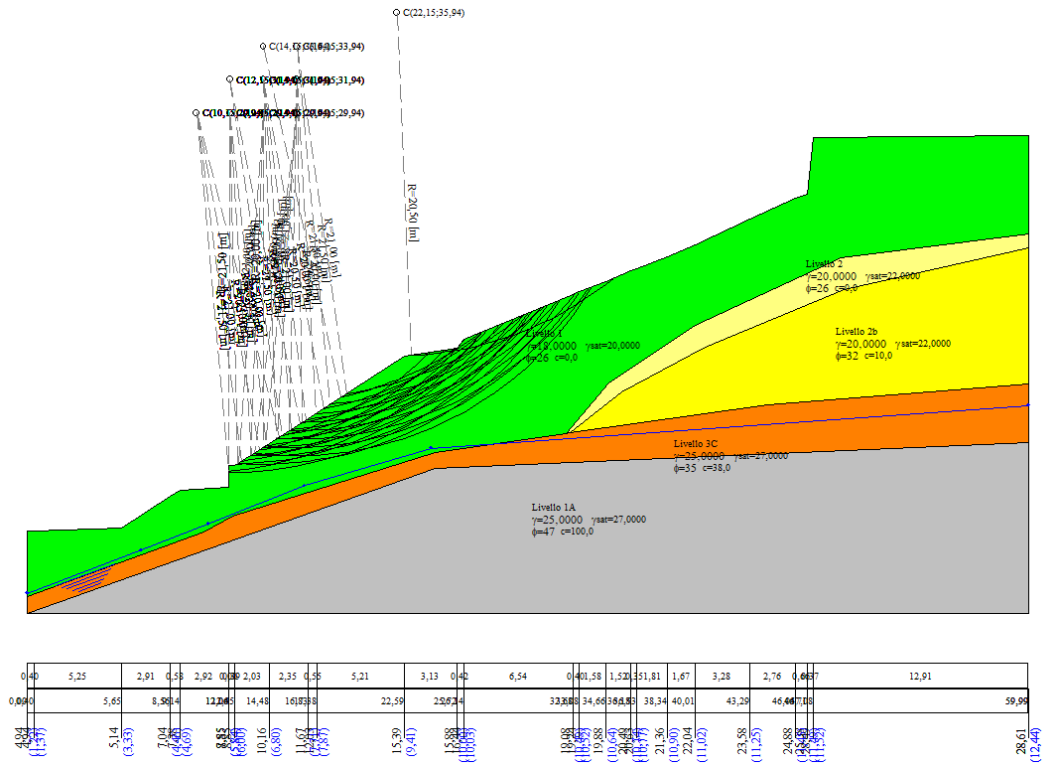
Sezione 8 stato di fatto. FS minimo 0.69
